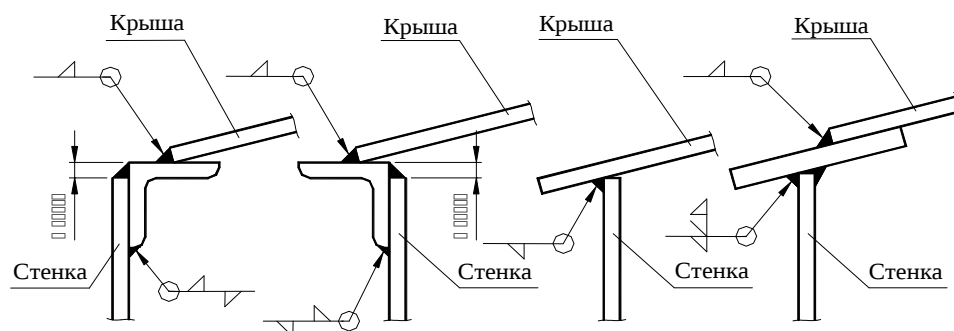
Узел крепления крыши к верху стенки резервуара
